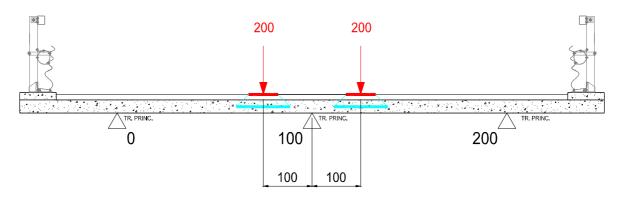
Minimo momento negativo su trave centrale - Schema di carico 2
